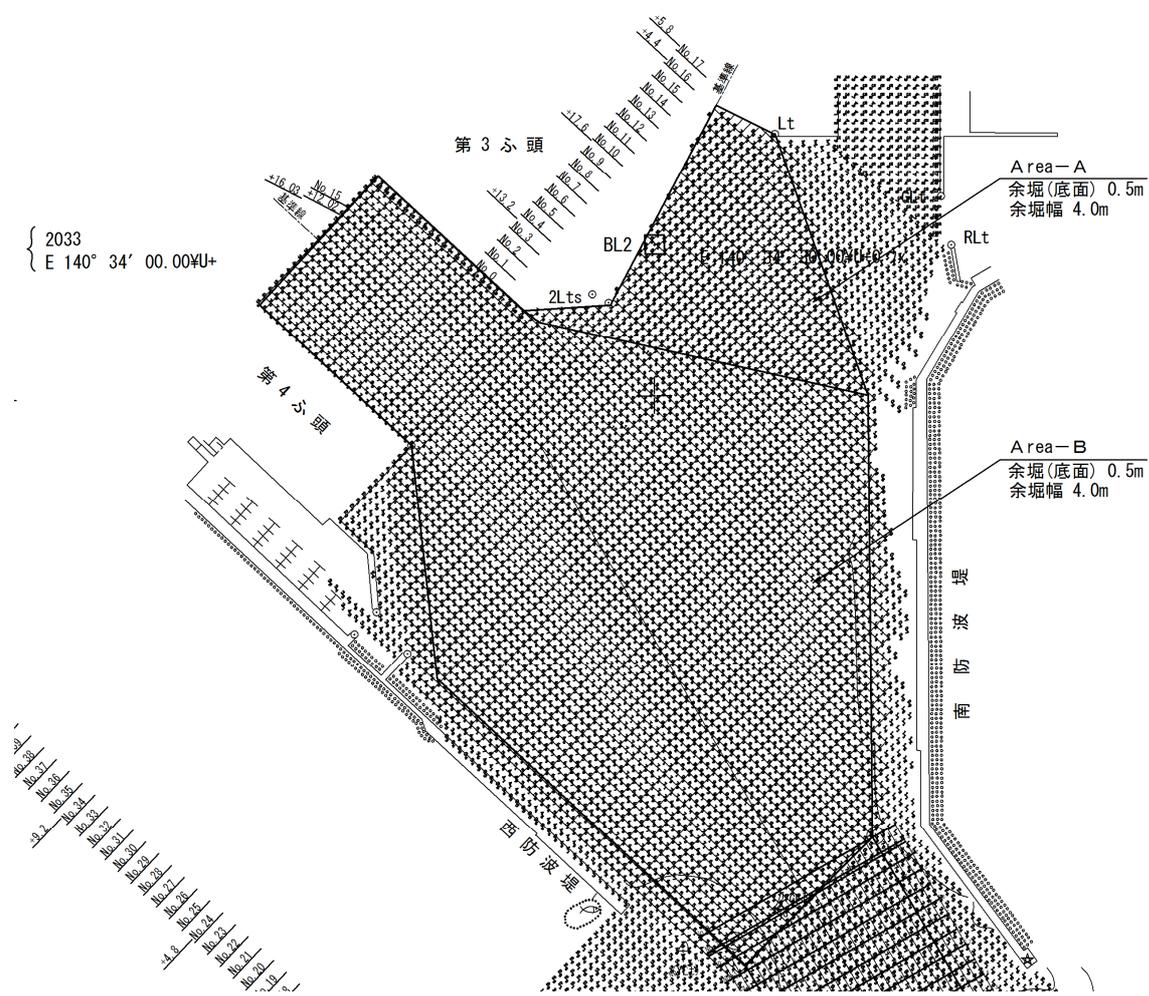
306 No.2 大洗港区_中央地区泊地 (-8m) の平面図 (被災前)
